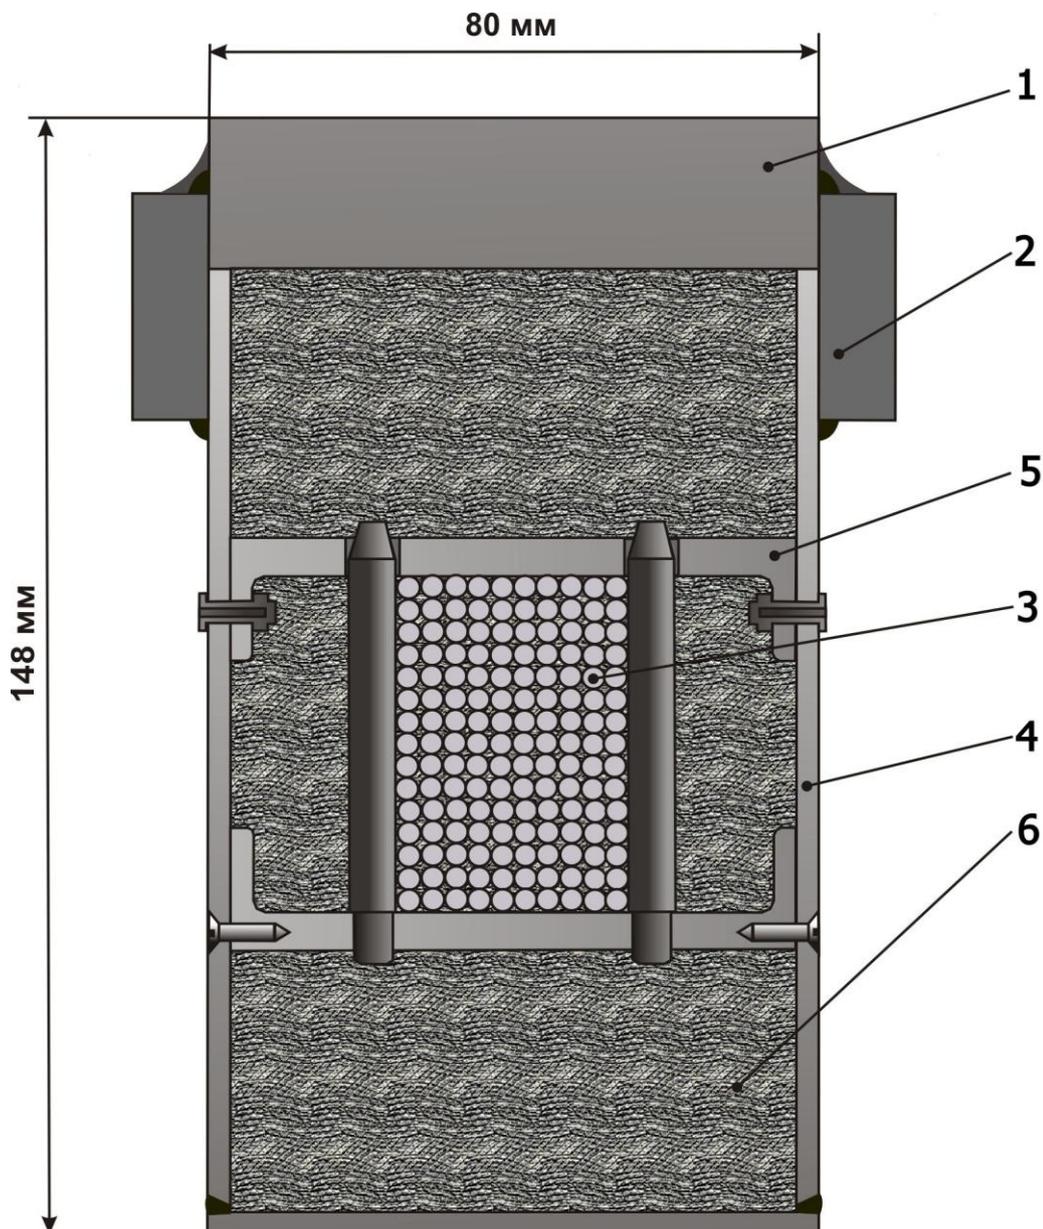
Конструкция рельса-струны бирельсового городского СТЮ для пролетов 35 м (масштаб 1:1): 1 — головка рельса (сталь, 20×80 мм); 2 — боковые щеки (сталь, 30×10 мм); 3 — высокопрочная проволока (сталь, Ø3, 150 штук, защищено герметиком); 4 — корпус (сварной швеллер, сталь, 128×80×3 мм); 5 — крепление струны к корпусу рельса; 6 — наполнитель (модифицированный бетон, содержащий пластификатор и ингибитор коррозии). Масса рельса-струны — 52,6 кг/м (масса бетона 19 кг/м).
